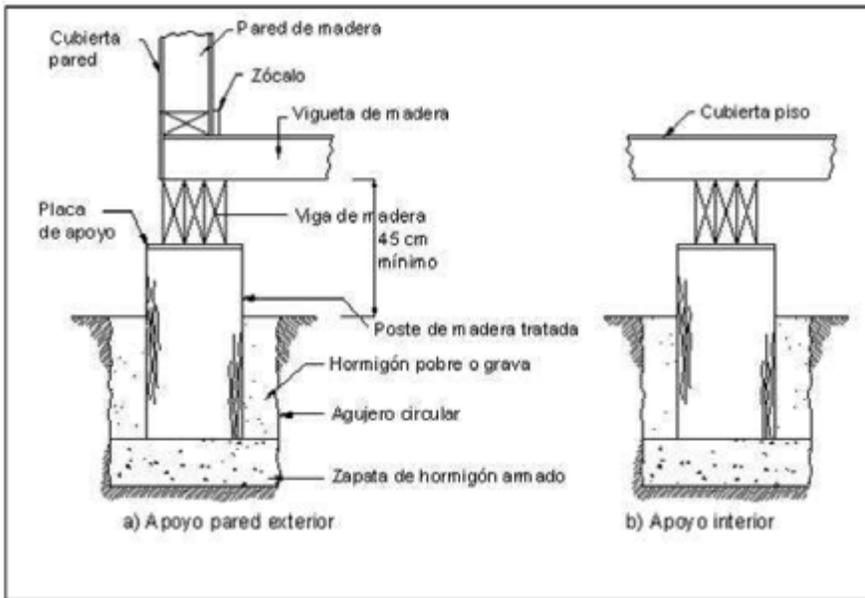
ANCLAJES DE VIGAS Y VIGUETAS
